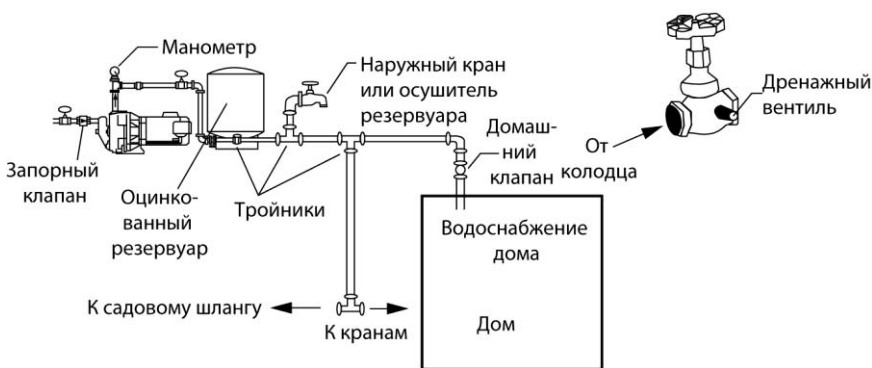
Типовая схема водопроводной системы от колодца к дому. Вентиль с краном для слива воды позволит осушить трубы в доме на зимний период
